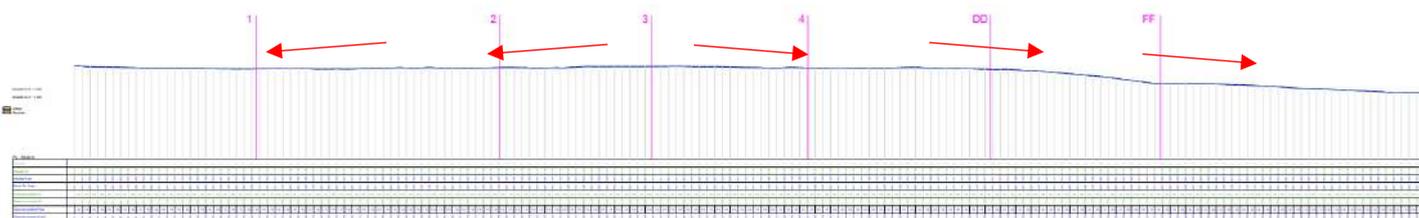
Ecoulement des eaux pluviales en pied de digue (profil en long)
